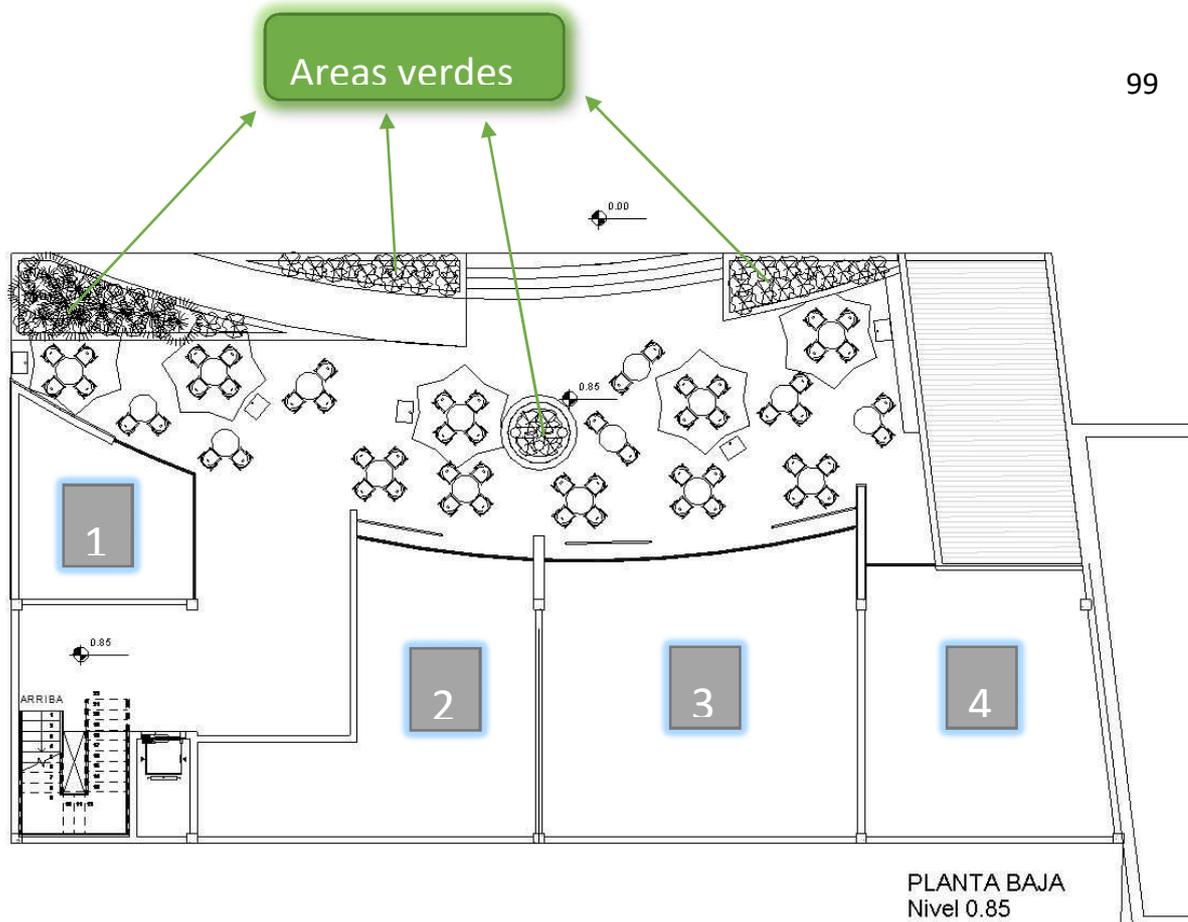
Planta Baja Elaborado por: Kast Arquitectura
